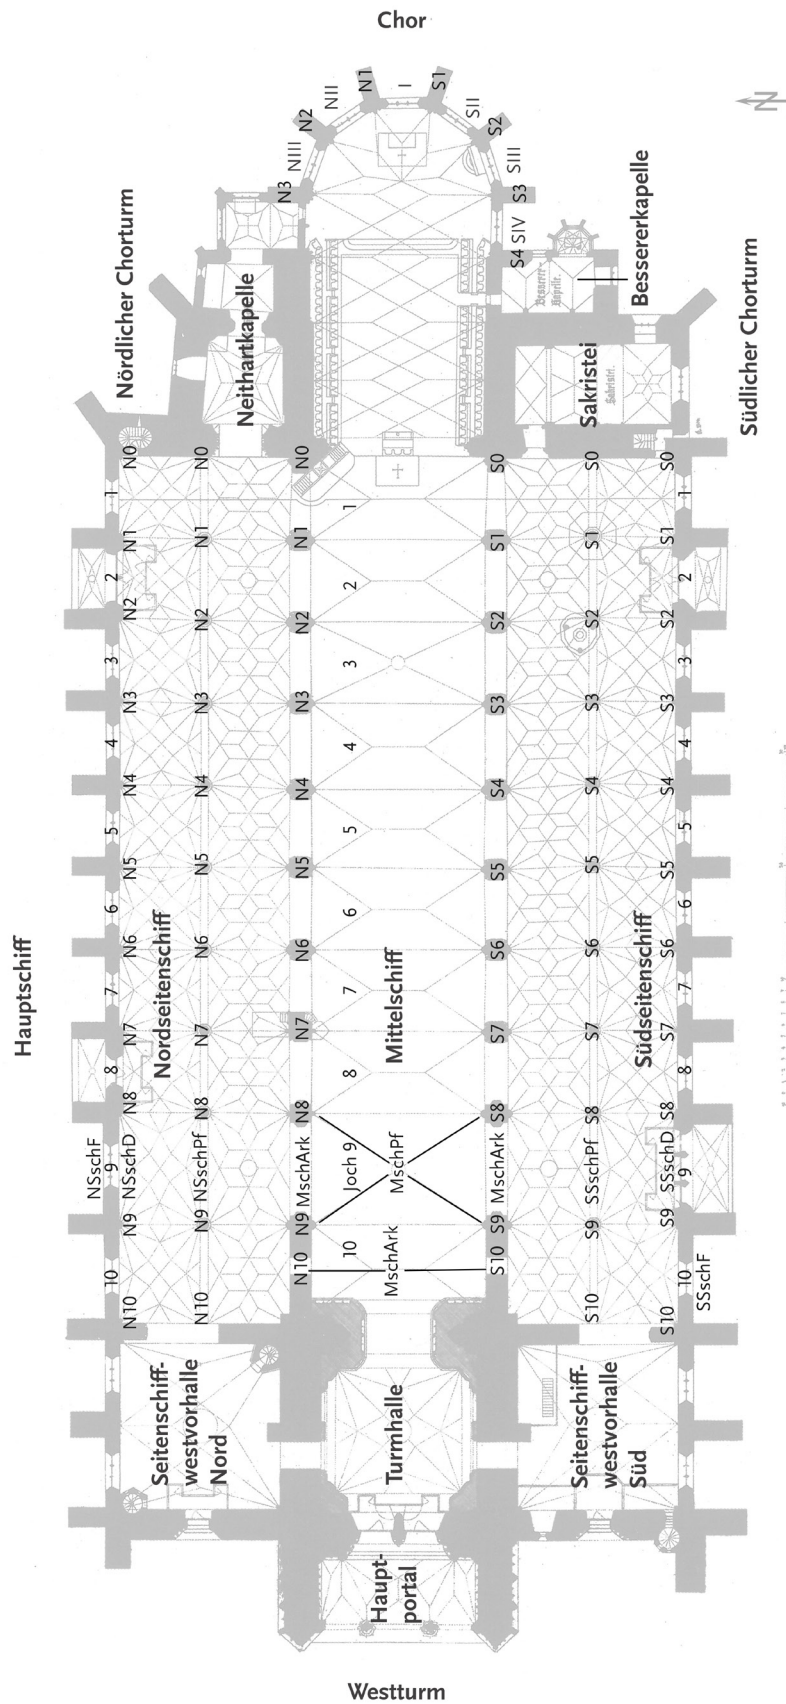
Bauteilbezeichnungen und deren Verortung im Grundriss
